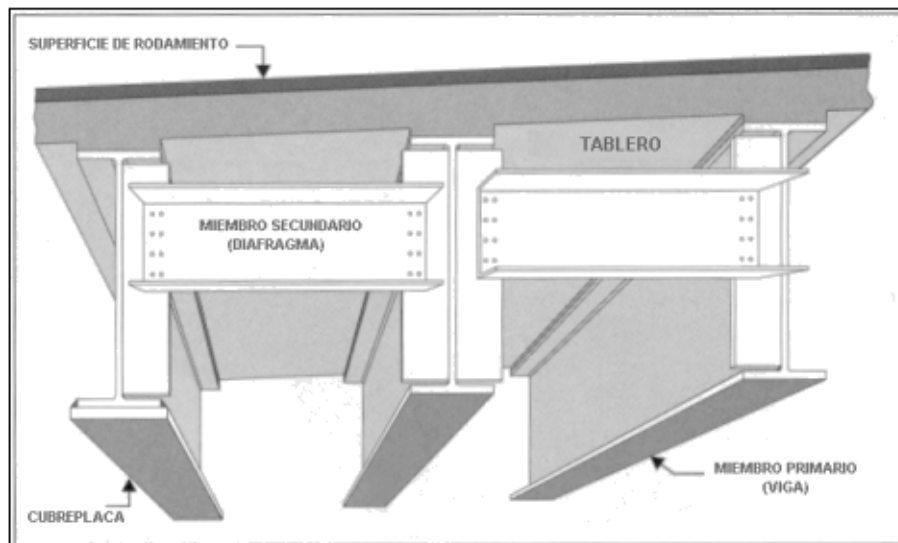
Componentes principales de la superestructura de un puente tipo MIXTO o losa sobre vigas.
